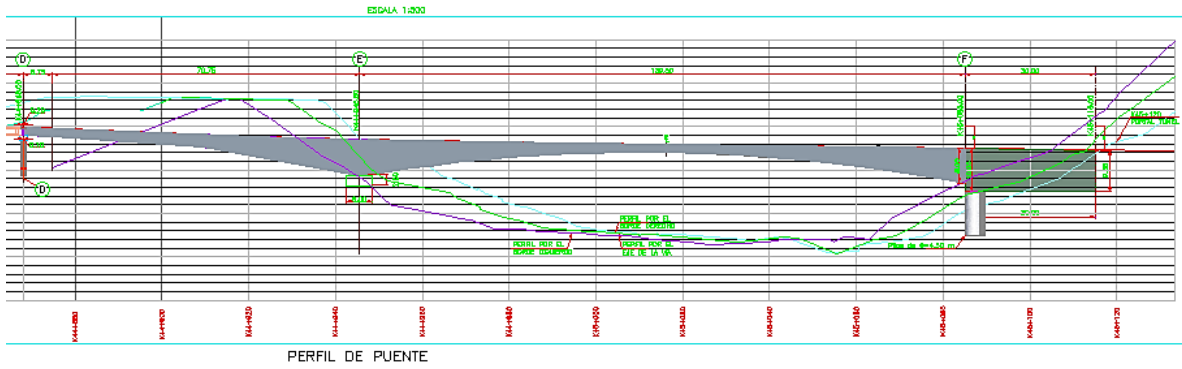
Vista alzada en perfil puente caso de estudio 4.
